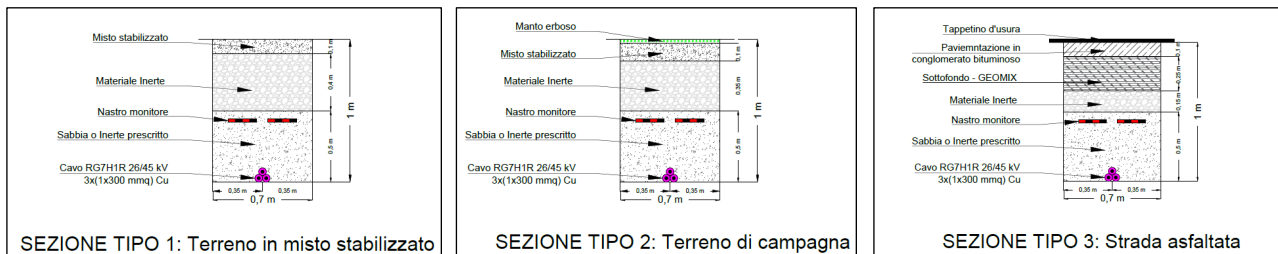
Tipici della sezione di scavo dei cavi AT di collegamento tra le Power Station e la Cabina di Smistamento
